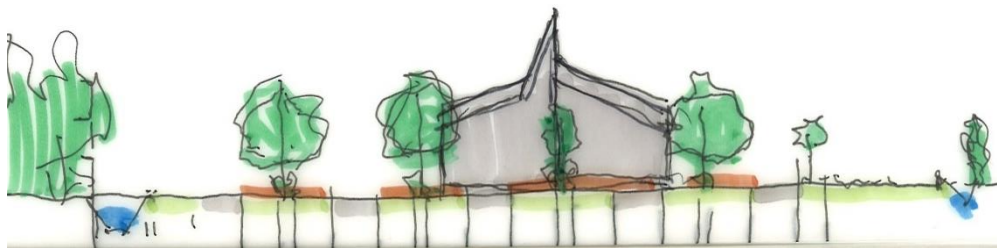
Inrichtingsplan met landschappelijke inpassing (uitvergroting opgenomen in bijlage 1)
